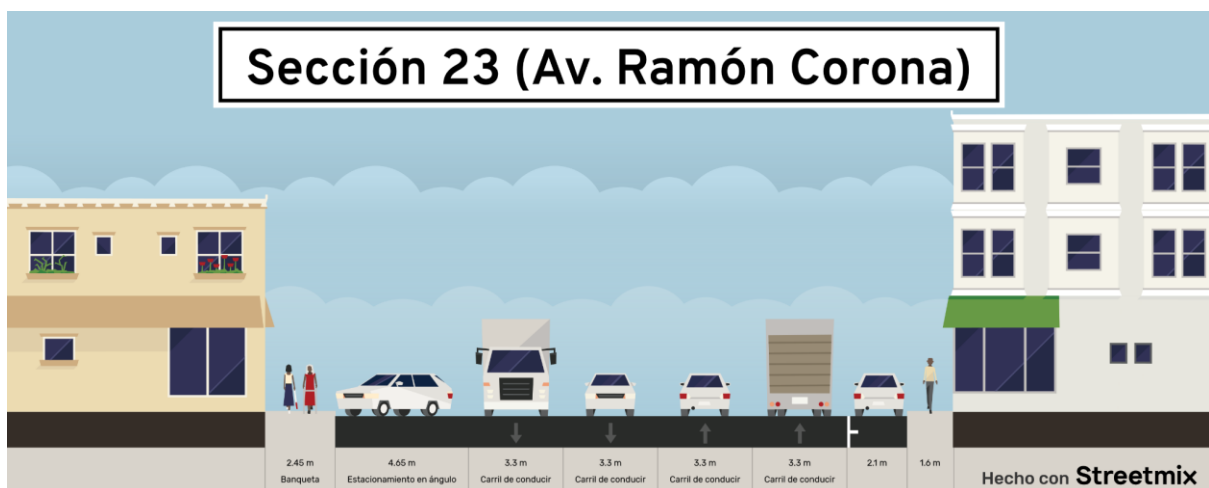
Sección de calle del estado actual. Avenida Ramón Corona (sección número 23) (Elaboración propia con herramienta Streetmix, 2022).
